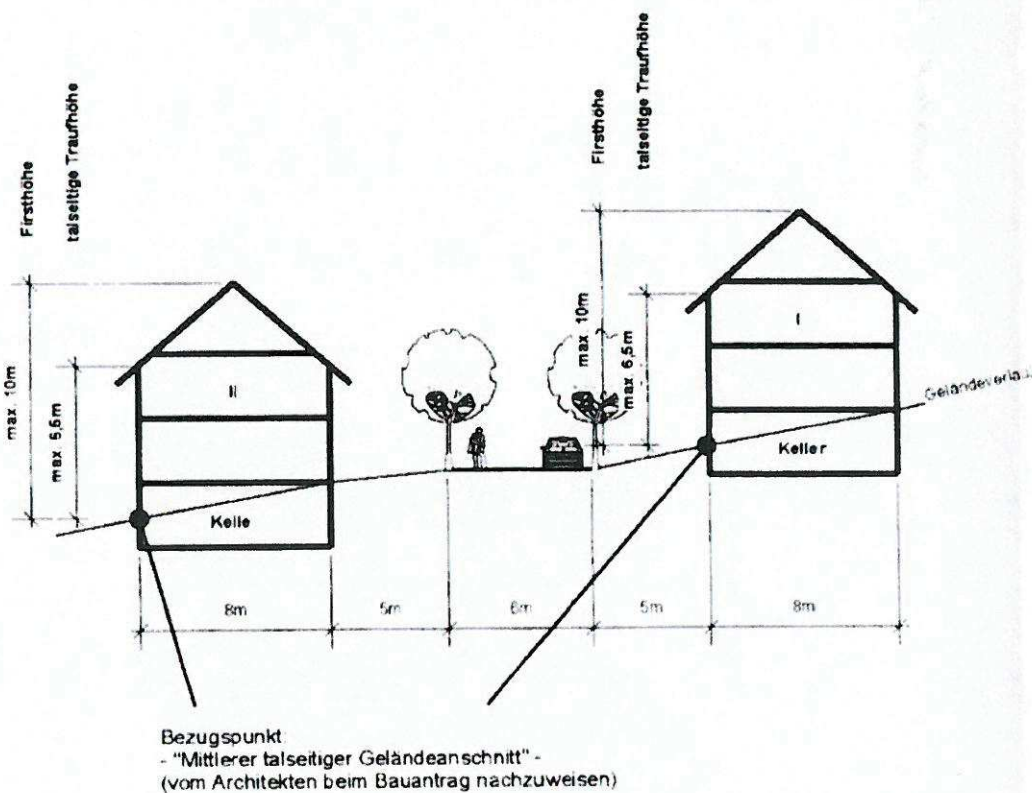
Bisherige Vorgabe der Höhenermittlung aus textl. Festsetzungen, Bebauungsplan „Pletschmühle“ (1998)
